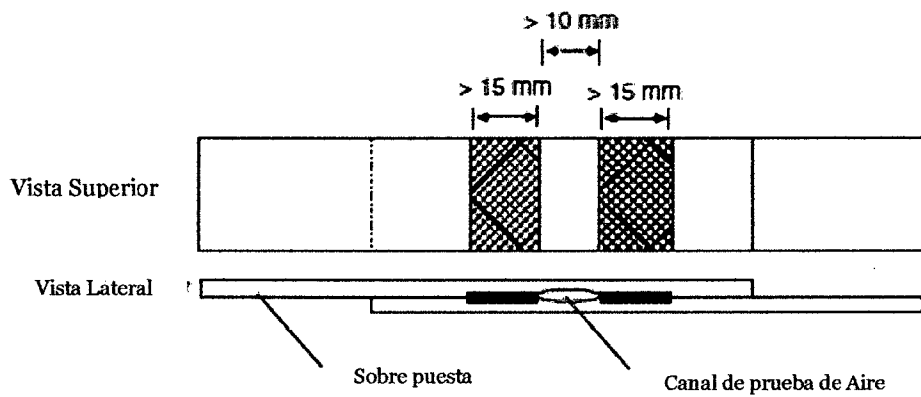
Esquema de Soldadura de láminas de geomembrana
